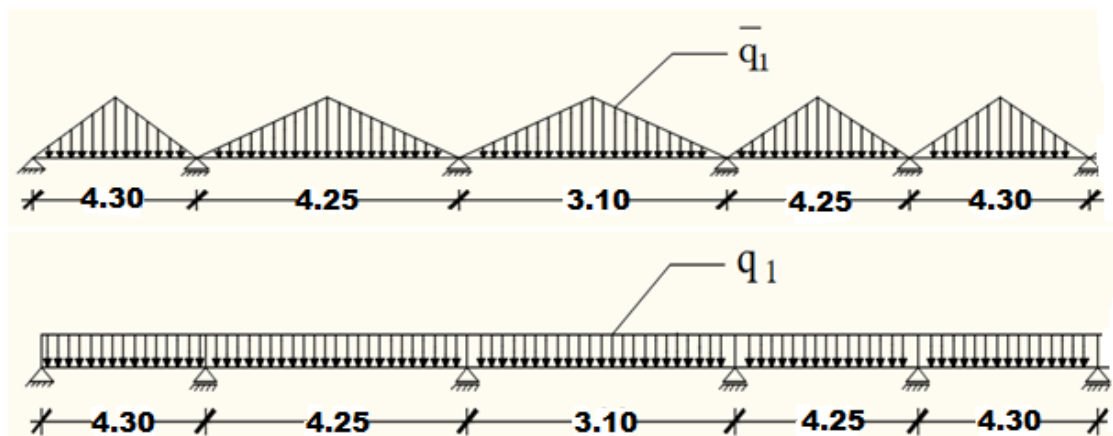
Distribution des charges sur les poutres secondaires
